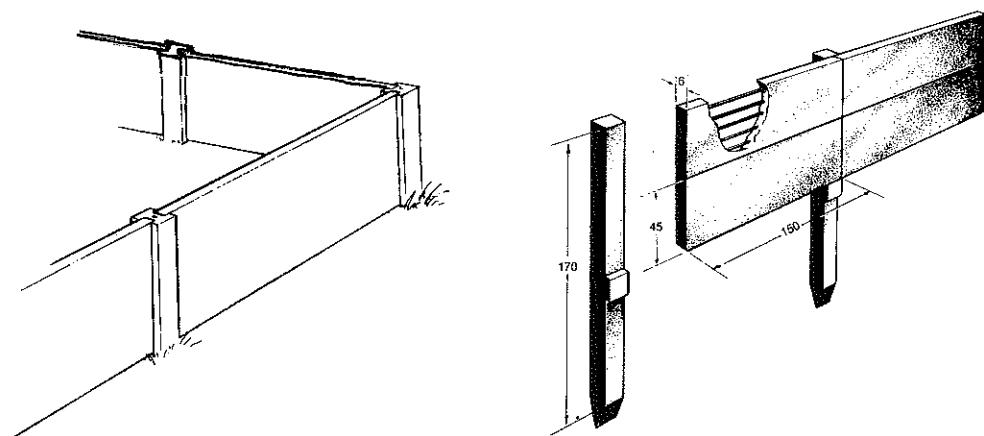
s. Palen en planken voor grondkering en beschoeiing ('Boot' beton).
